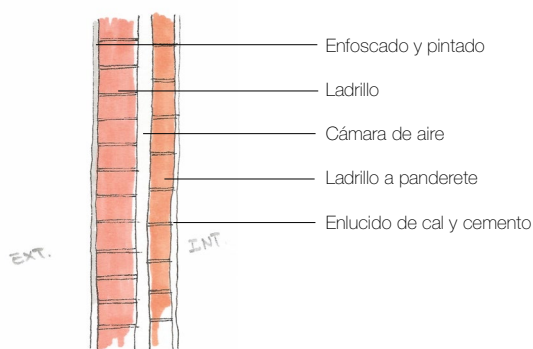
Detalle en sección de la pared Norte y la pared Sur (acceso), acabado enfoscado (autoría propia).
